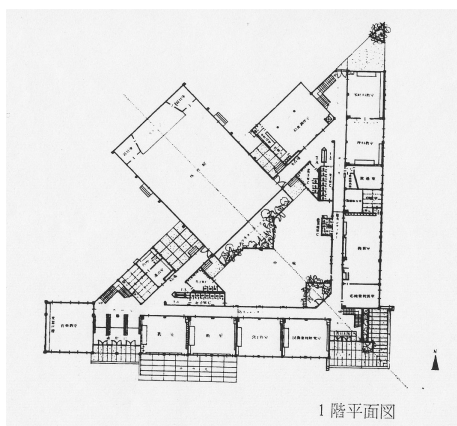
阿寒小学校校舎1階平面図, 1965,
